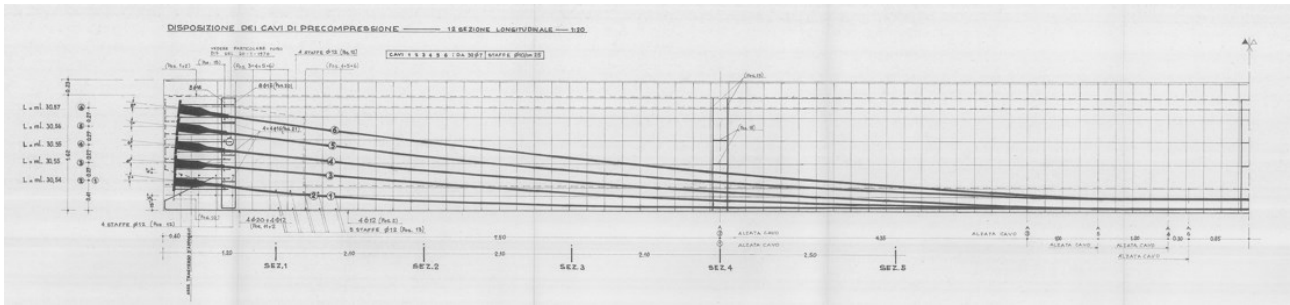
Disposizione dei cavi di precompressione, vista longitudinale
